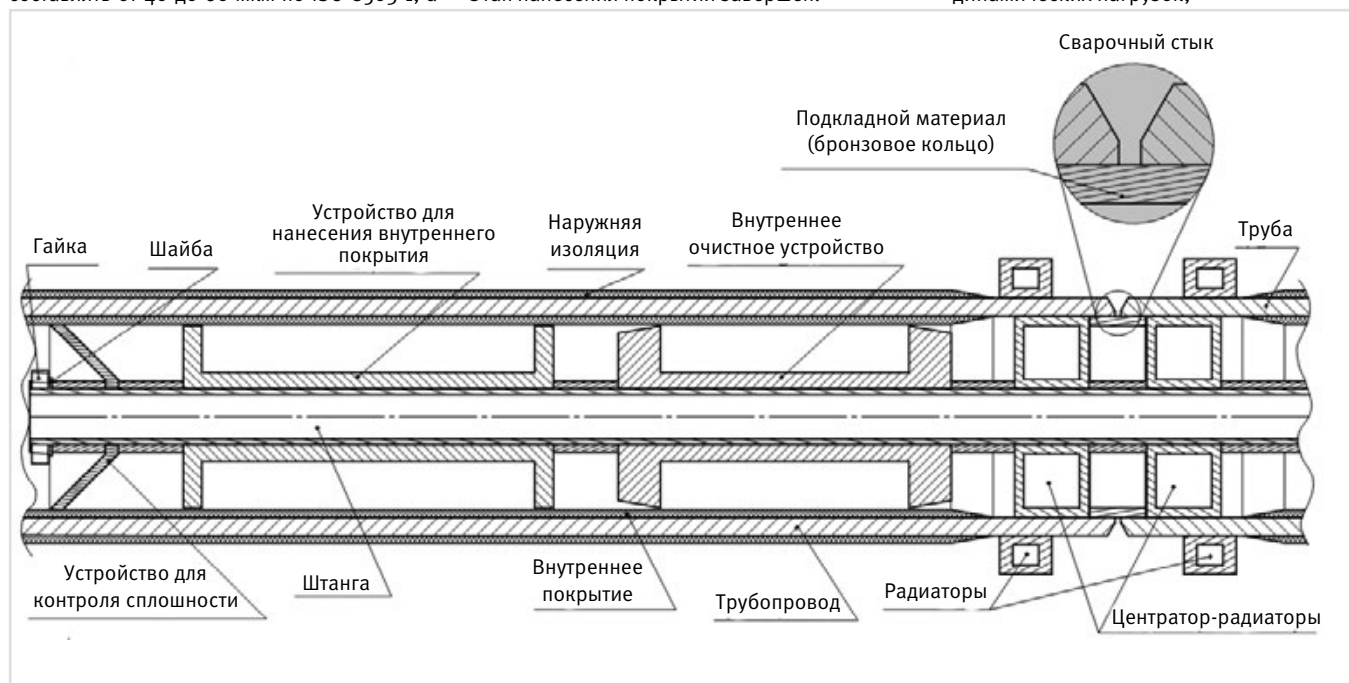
Устройство для соединения труб, размещенное внутри трубопровода и стыкуемой трубы
